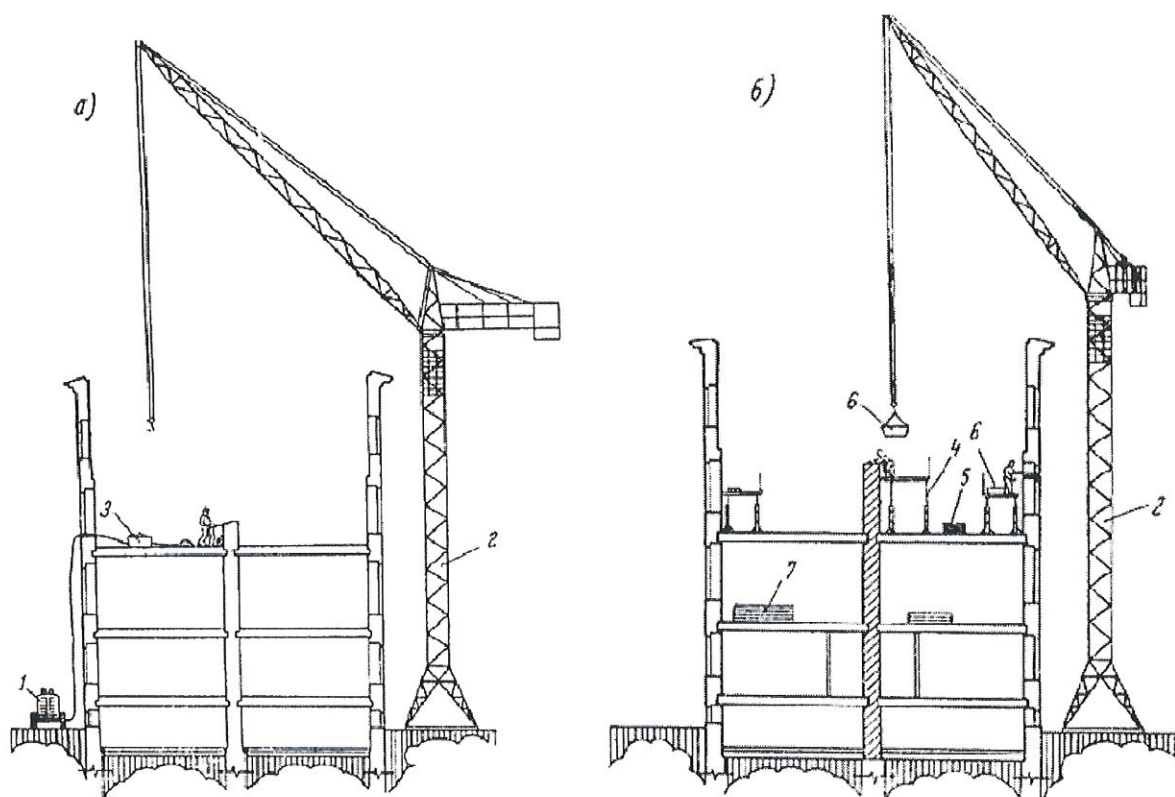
Общая схема организации работ по перекладке участка стены при комплексном капитальном ремонте жилого дома
